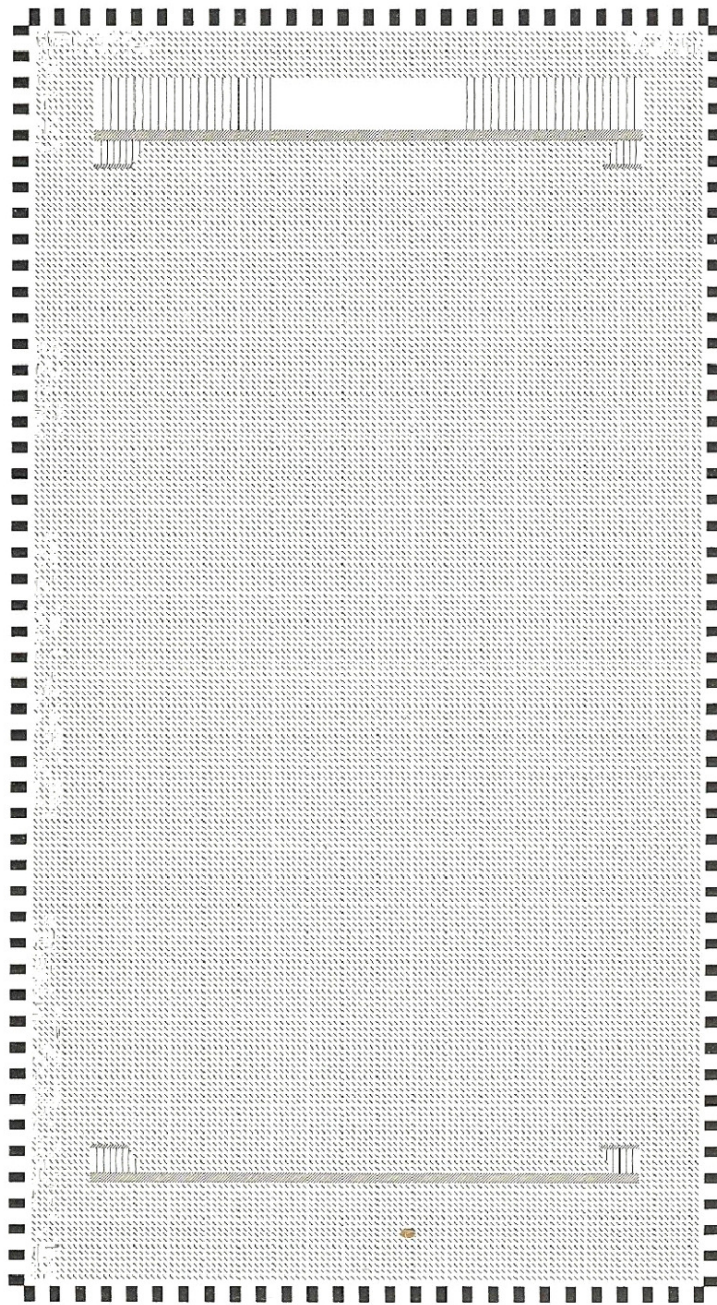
Pianta (con sezione dei pilastri perimetrali)
